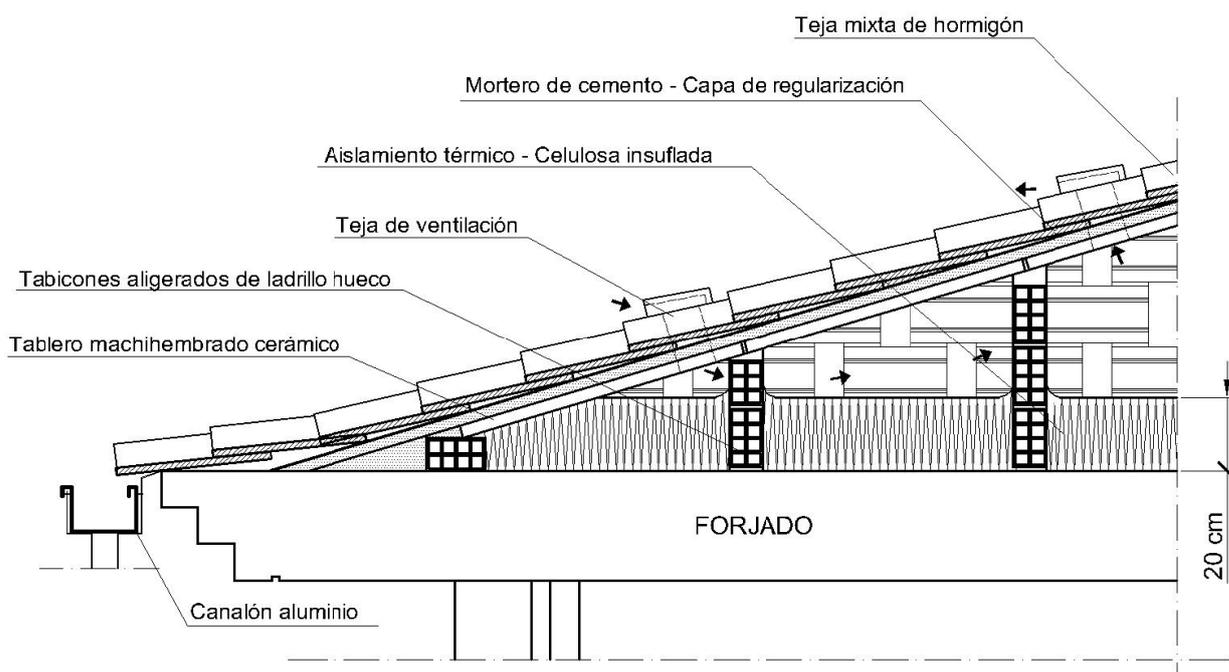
Sección cubierta alternativa – Cubierta fría
